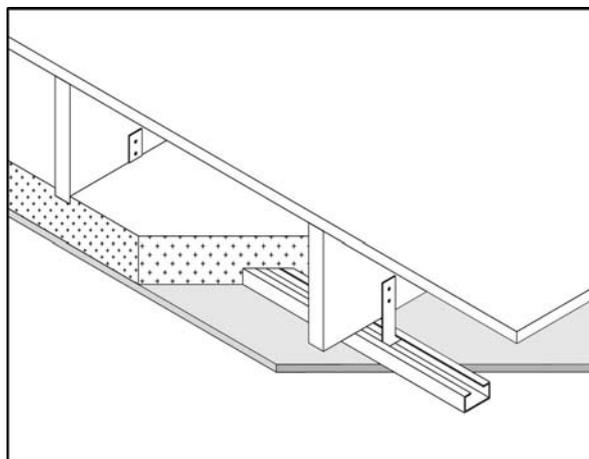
Plancher stable au feu 1/2h avec écran 1/2h
